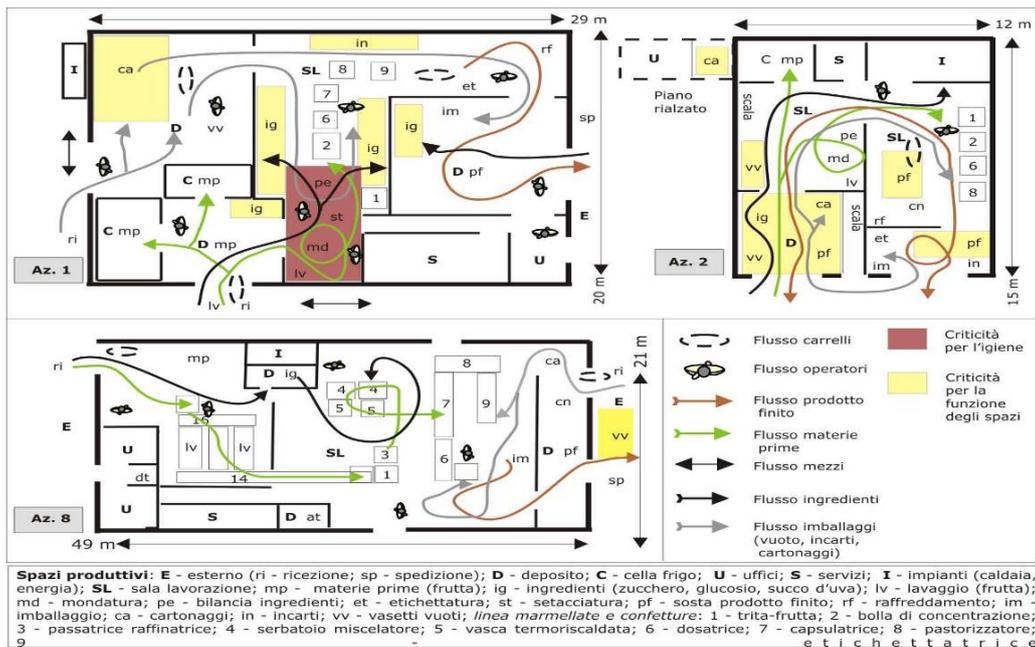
Schemi planimetrici di alcune aziende rilevate
